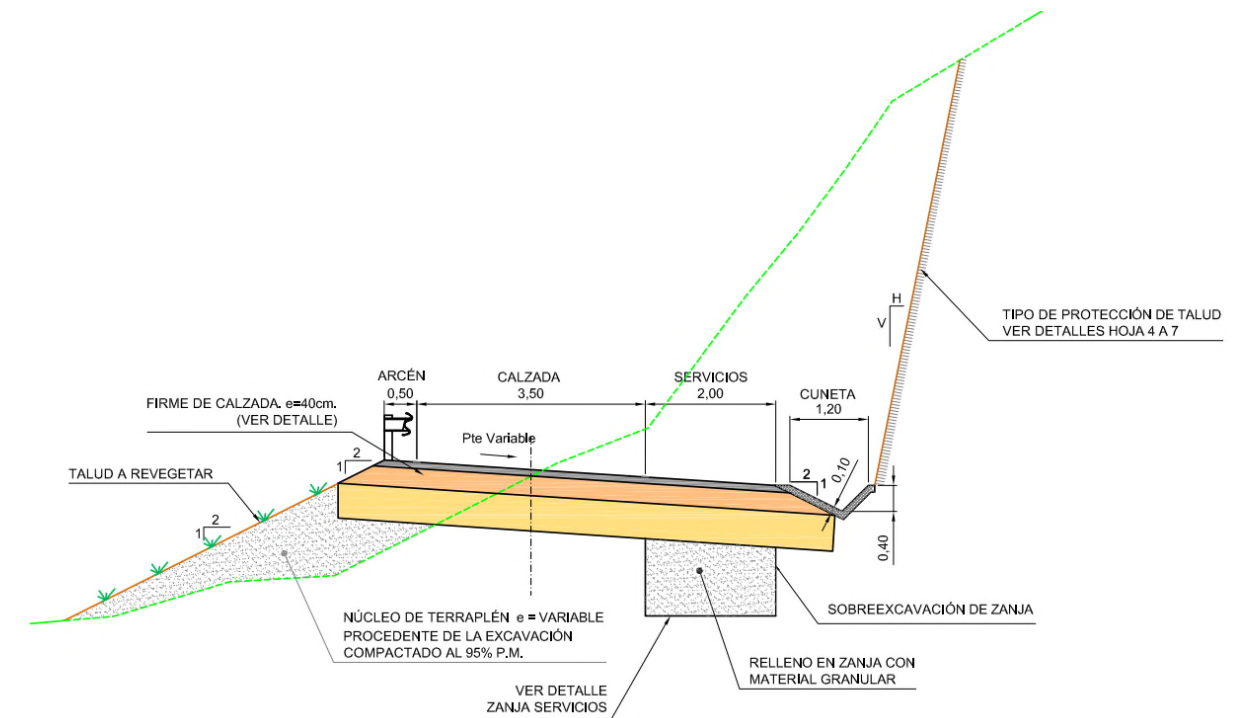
Sección tipo del tramo 2 de la carretera en la alternativa 1 (PIGA 2012).
